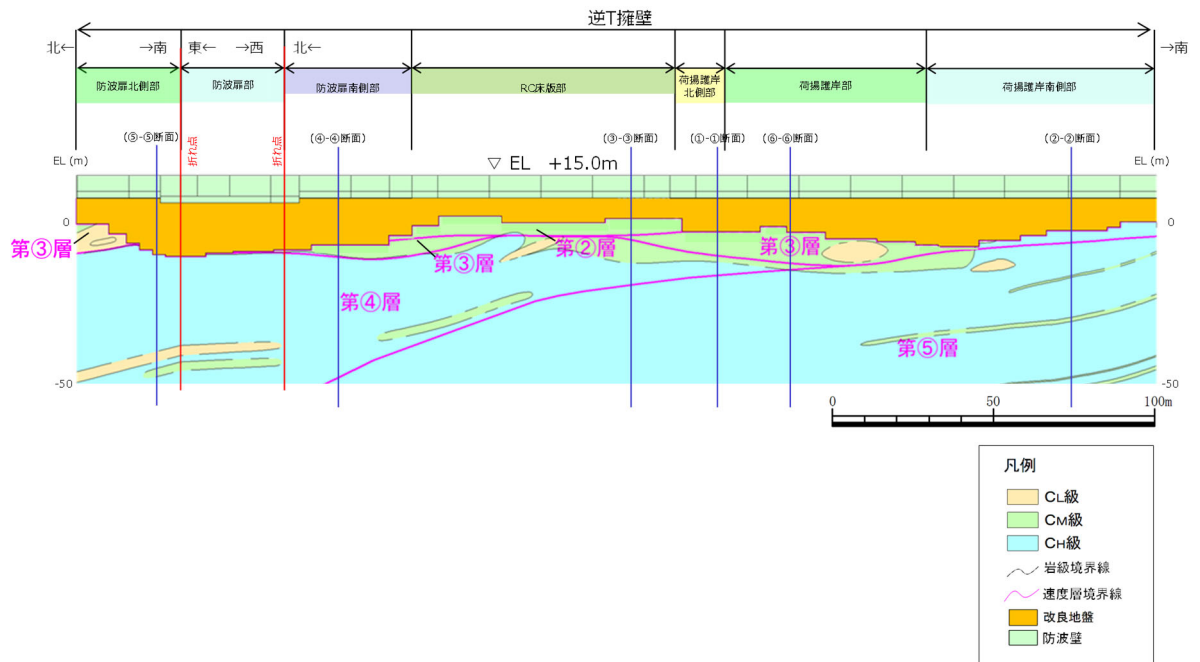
防波壁（逆 T 擁壁）縦断面図
